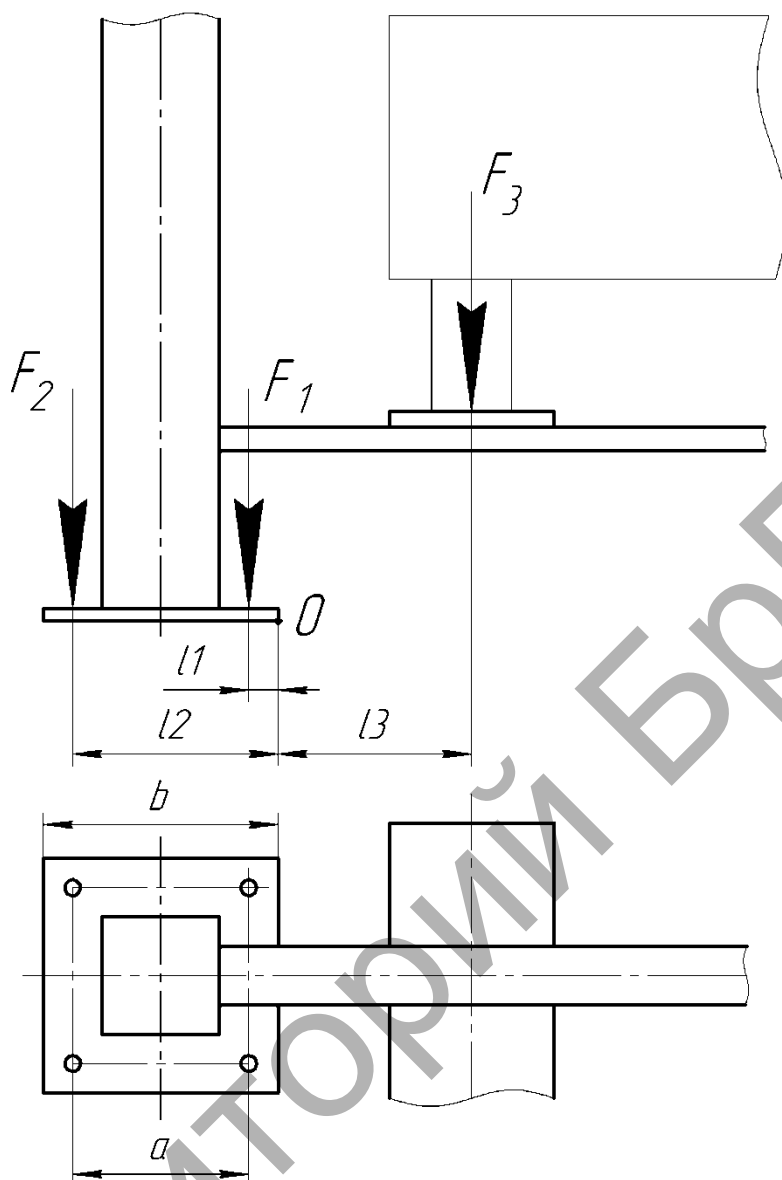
Расчетная схема для расчета фундаментных болтов
